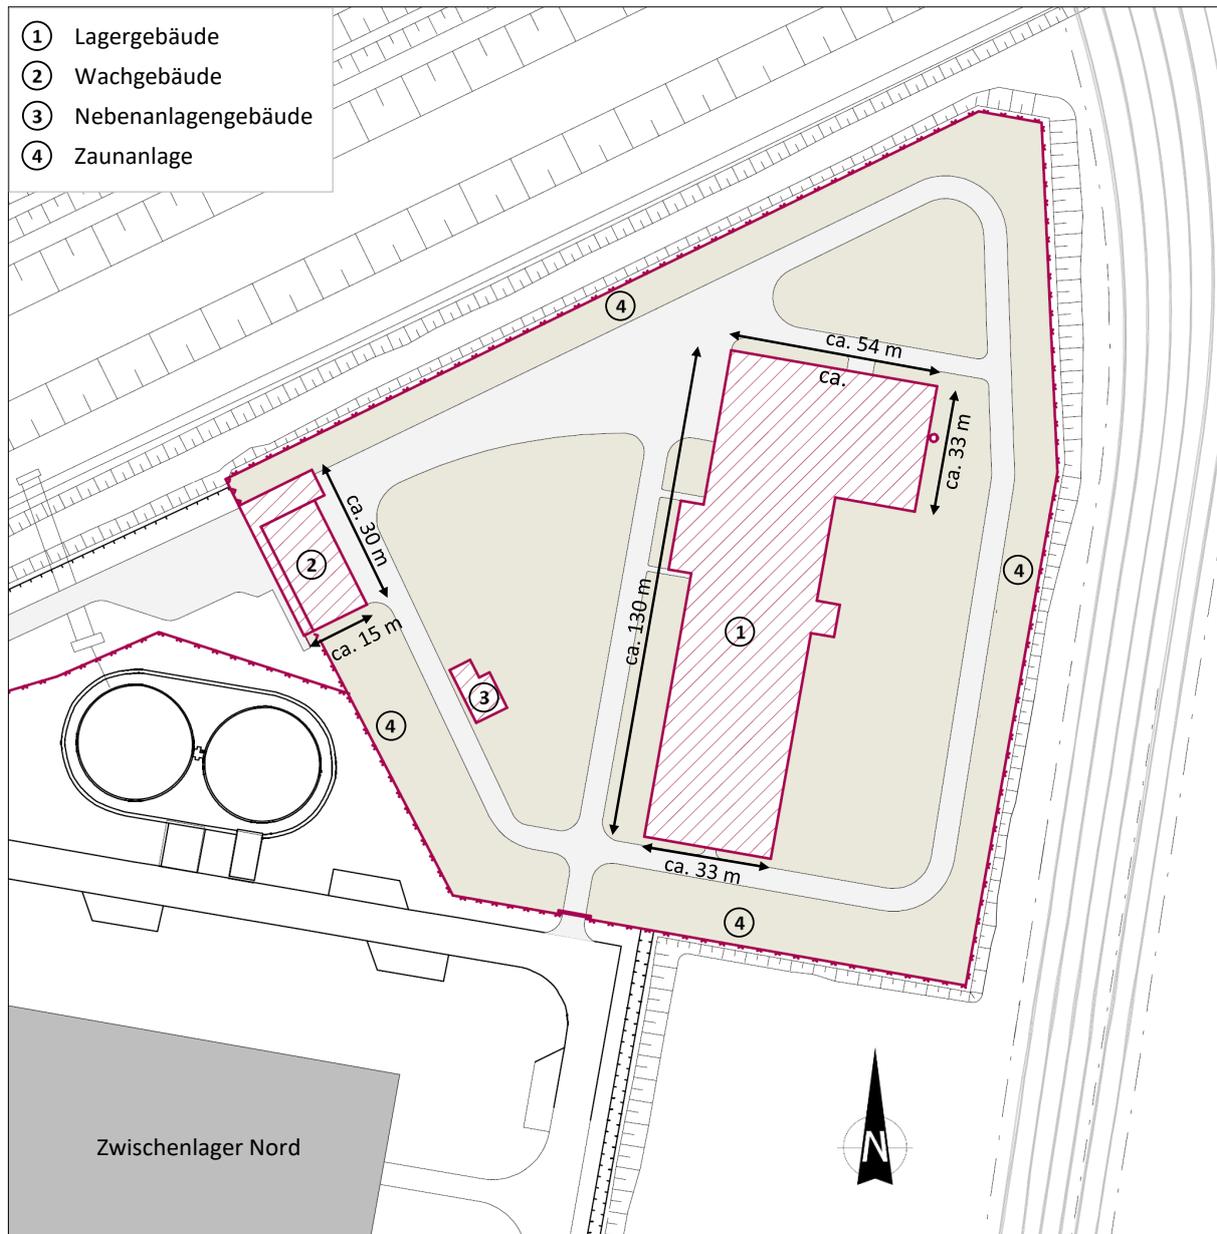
Lageplan des Betriebsgeländes ESTRAL mit Darstellung der Gebäude und der Außenanlagen
